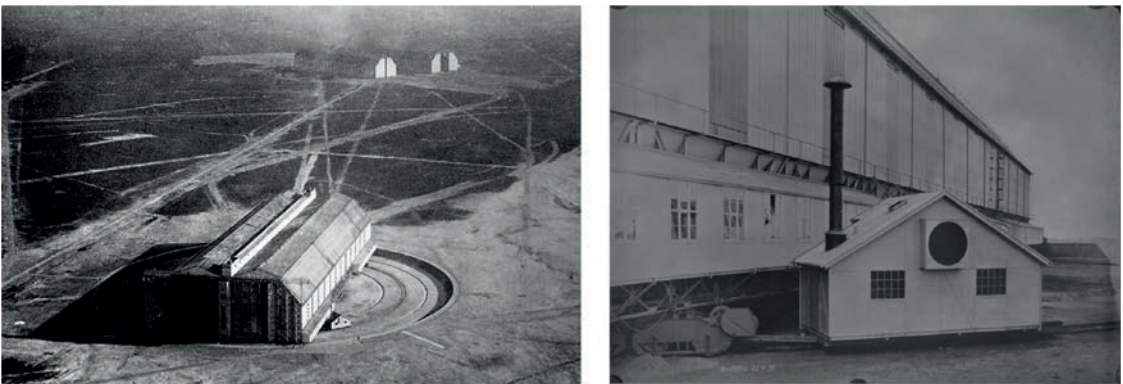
Drehhalle „Nobel“ Luftaufnahme (1915). Links mit den Hallen „Nora“ und „Norbert“, rechts Detail mit Laufwagen auf dem Schienenkranz und dem zur Sicherheit außerhalb der Halle angebrachten Kesselhaus mit Heizanlage (Fotos: Archiv Aeronautikum).
